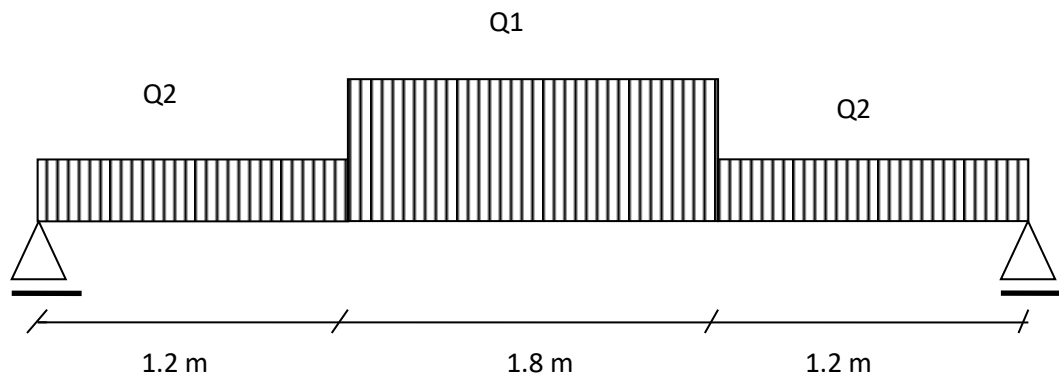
schéma statique d'un escalier a poutre palière escalier
